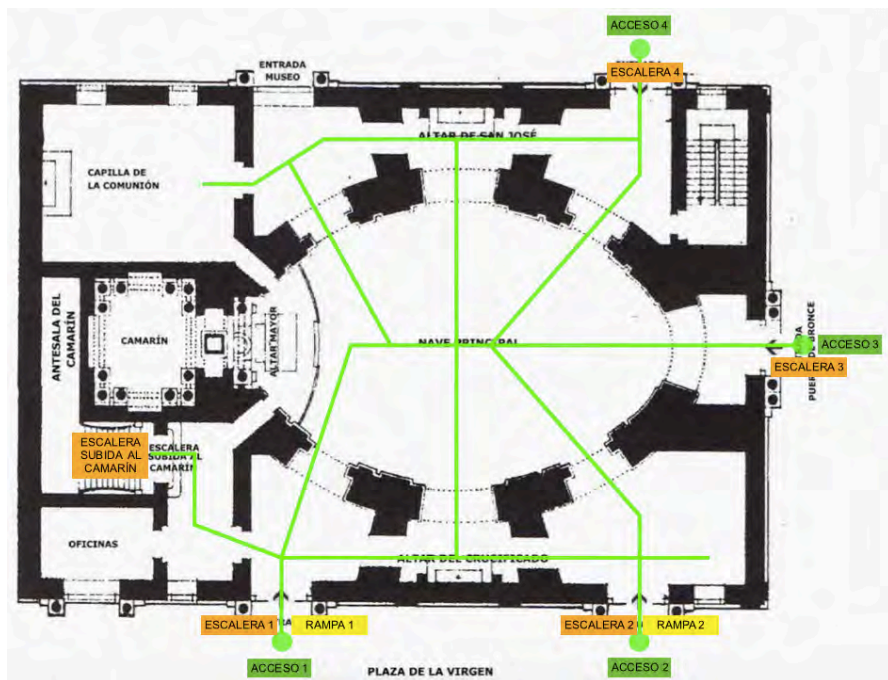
Sección de la planta de la Basílica indicando los accesos y recorridos (Fuente: www.jdiezarnal.com Plano modificado por el autor)
